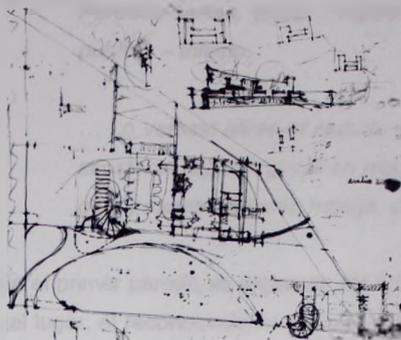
Croquis de planta de conjunto, Casa Medina 2001
